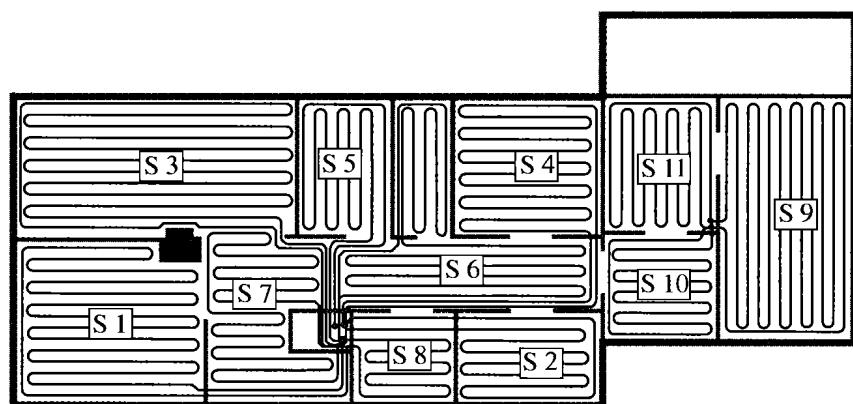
Пример укладки отопительных змеевиков труб в бетонном полу.
